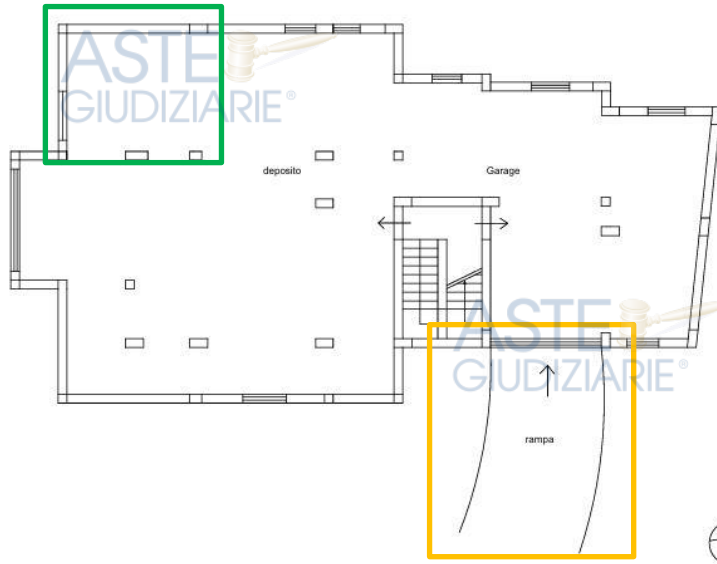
Planimetria Sub 5 e 6 unite di fatto Progetto Urbanistico Piano S1
